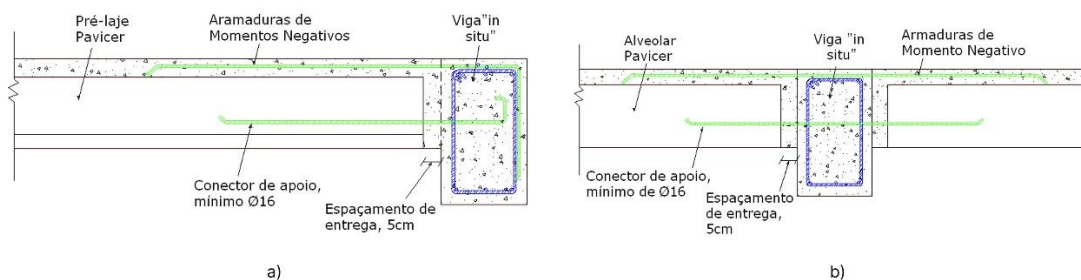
Pormenores construtivos de ligação entre laje alveolar e viga *in situ*: (a) viga de extremidade; (b) viga intermédia (adaptado de [12])
